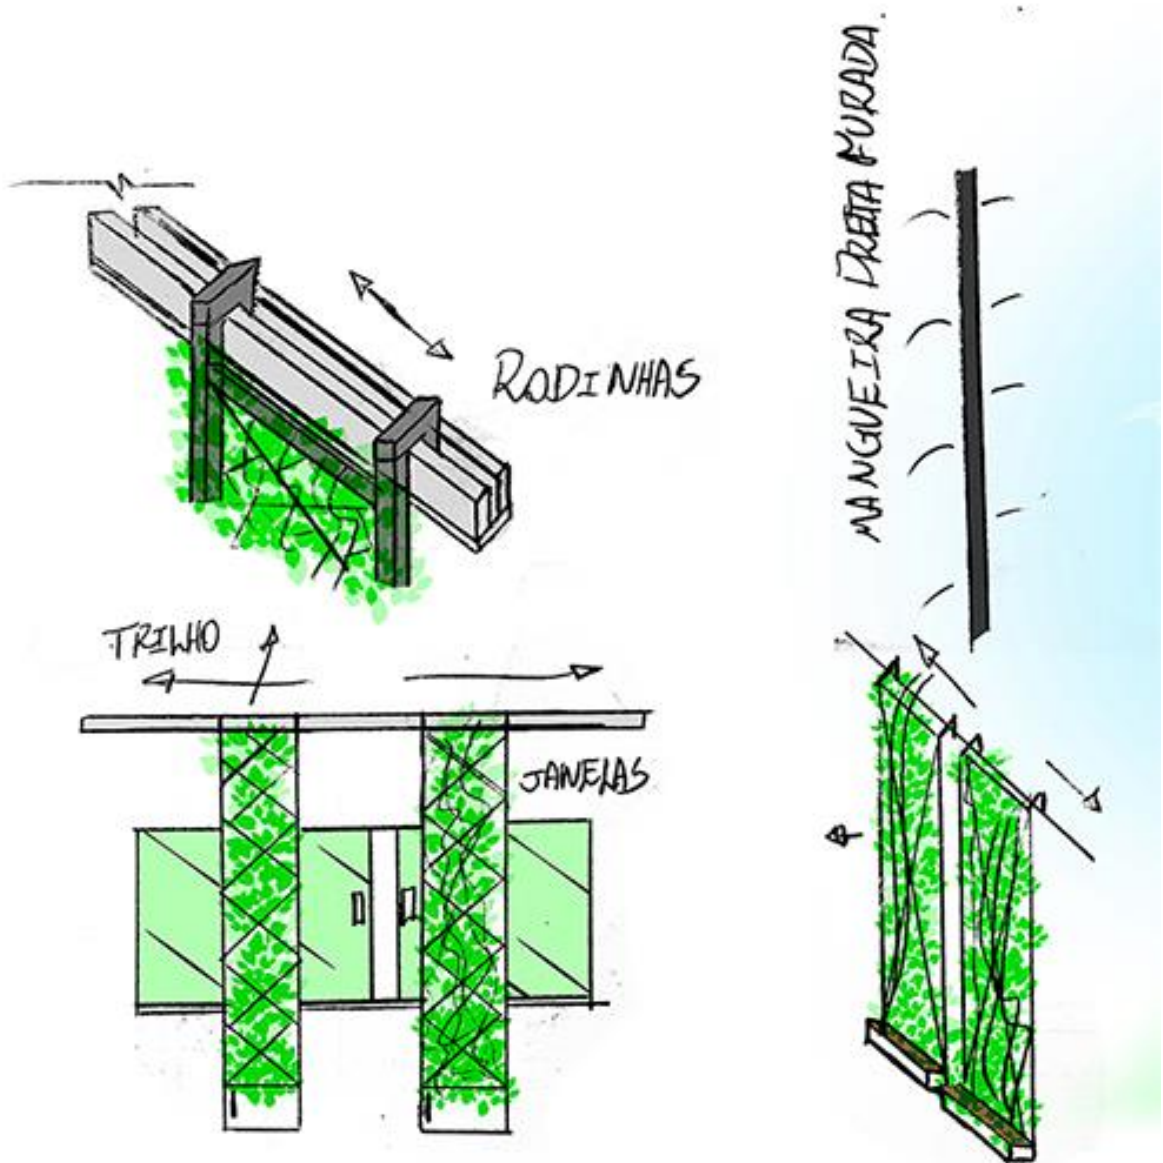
Croqui esquemático demonstrado proposta de fachada verde móvel
